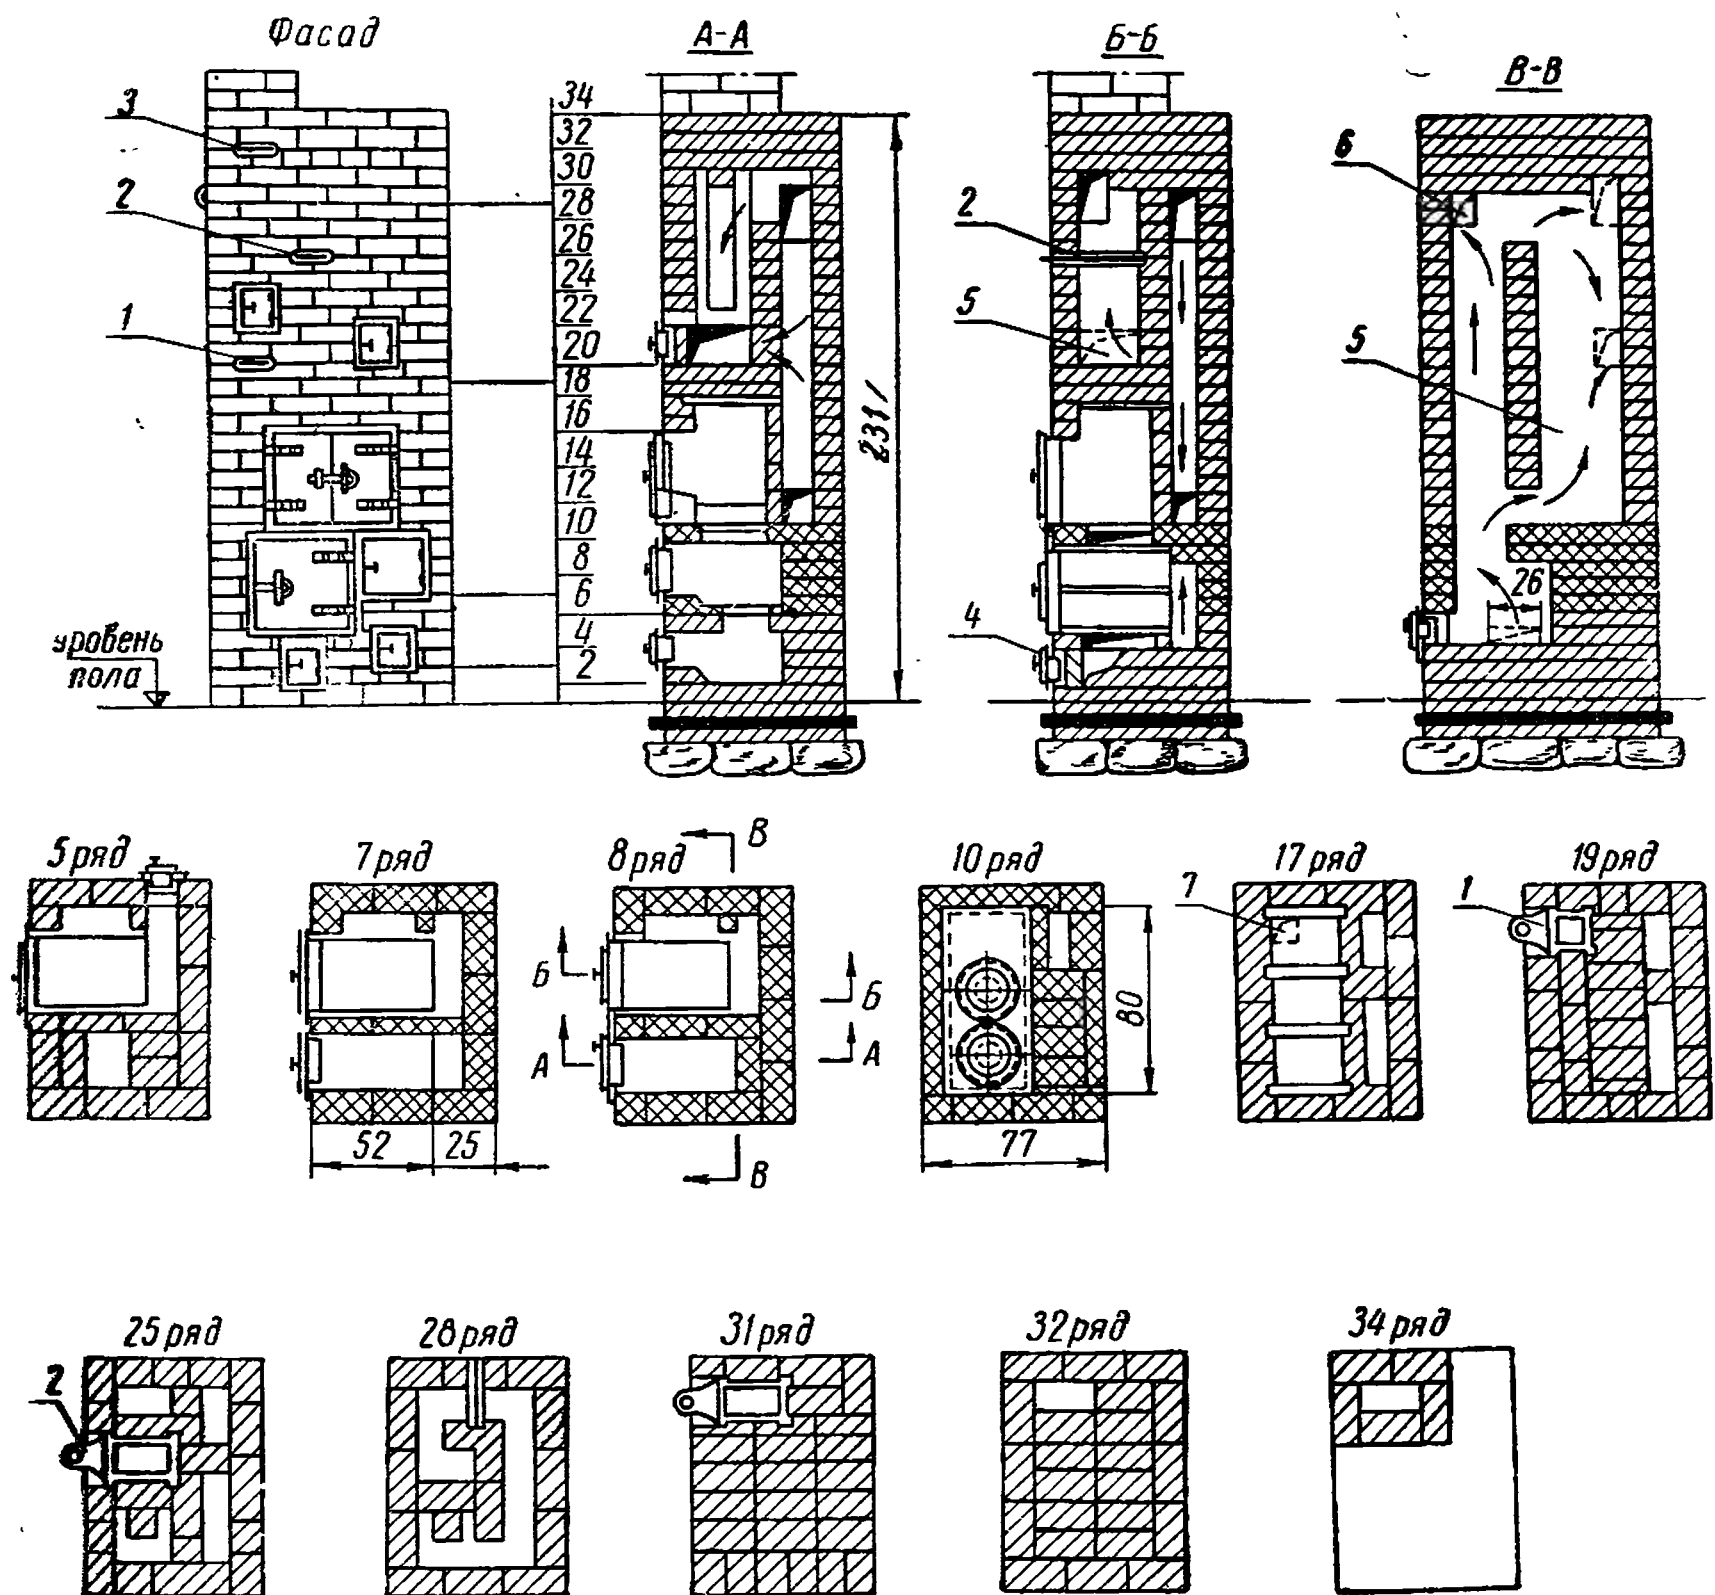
Отопительно-варочная печь конструкции Л. А. Коробанова и Н. И. Самарина:
